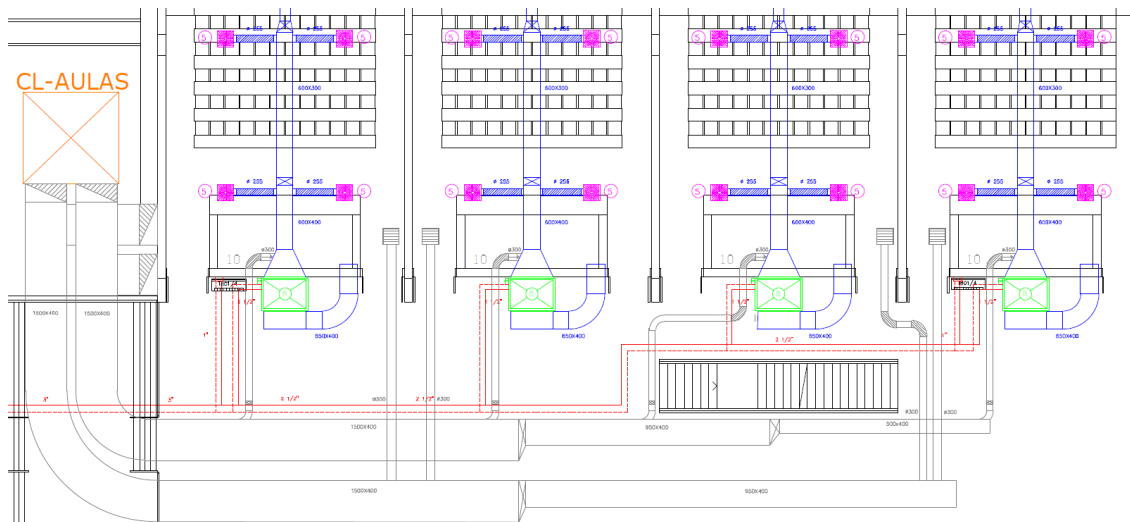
Vista de la climatizadora de las aulas este en la planta segunda. Fuente: Elab. propia.
